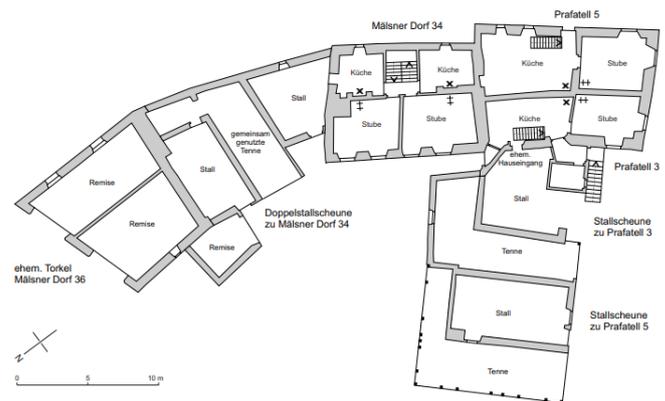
Grundriss Untergeschoss / Erdgeschoss 1:250.
